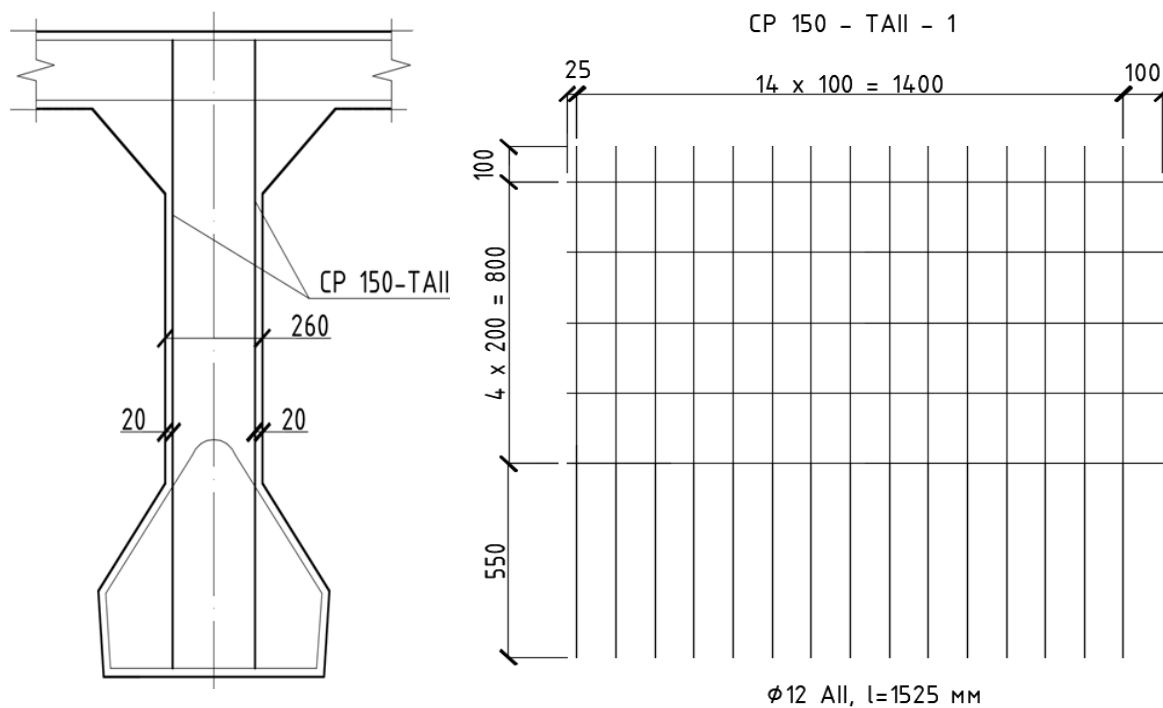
Армирование стенки крайней балки вблизи опорного сечения
